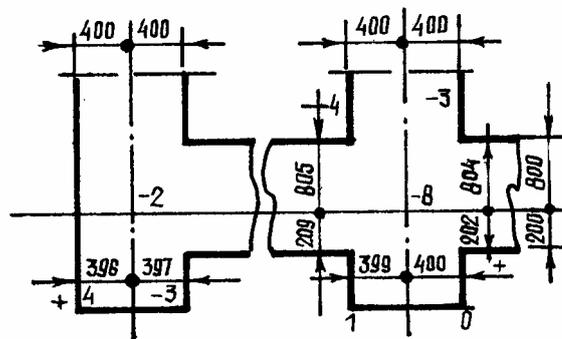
Исполнительная схема плано-высотной съемки котлована:
